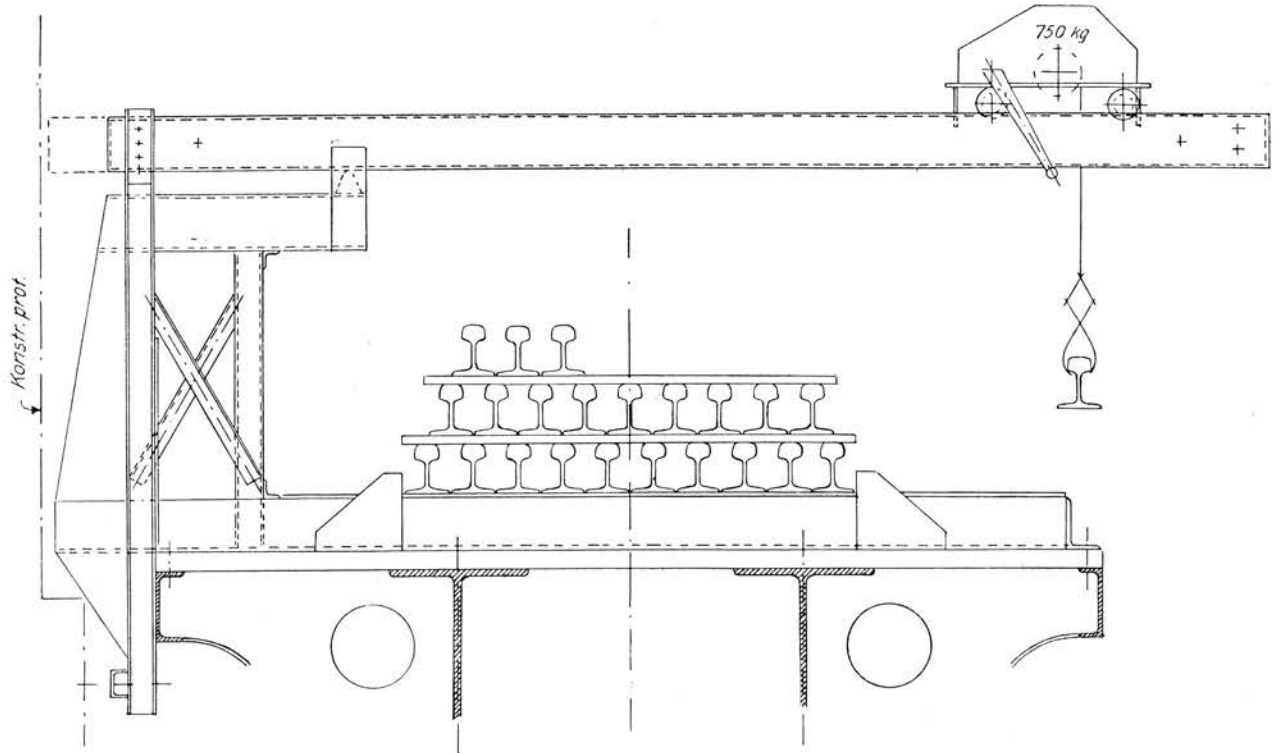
Hånddreven løpekatt på regulbar utligger for avlasting av skinner.
